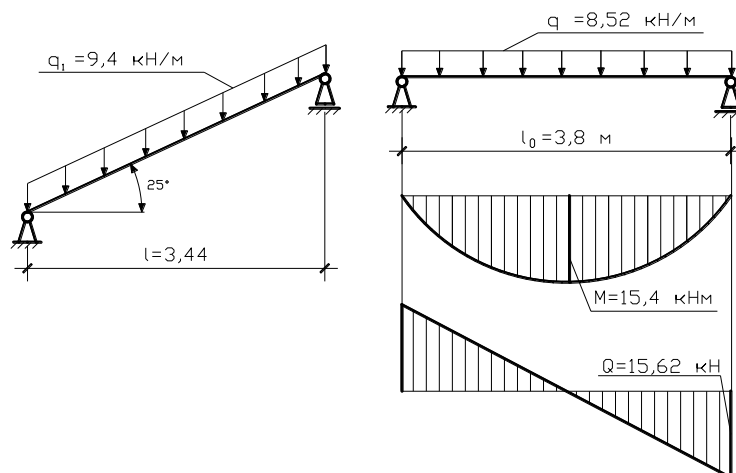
Розрахункова схема збірного залізобетонного сходового маршу
